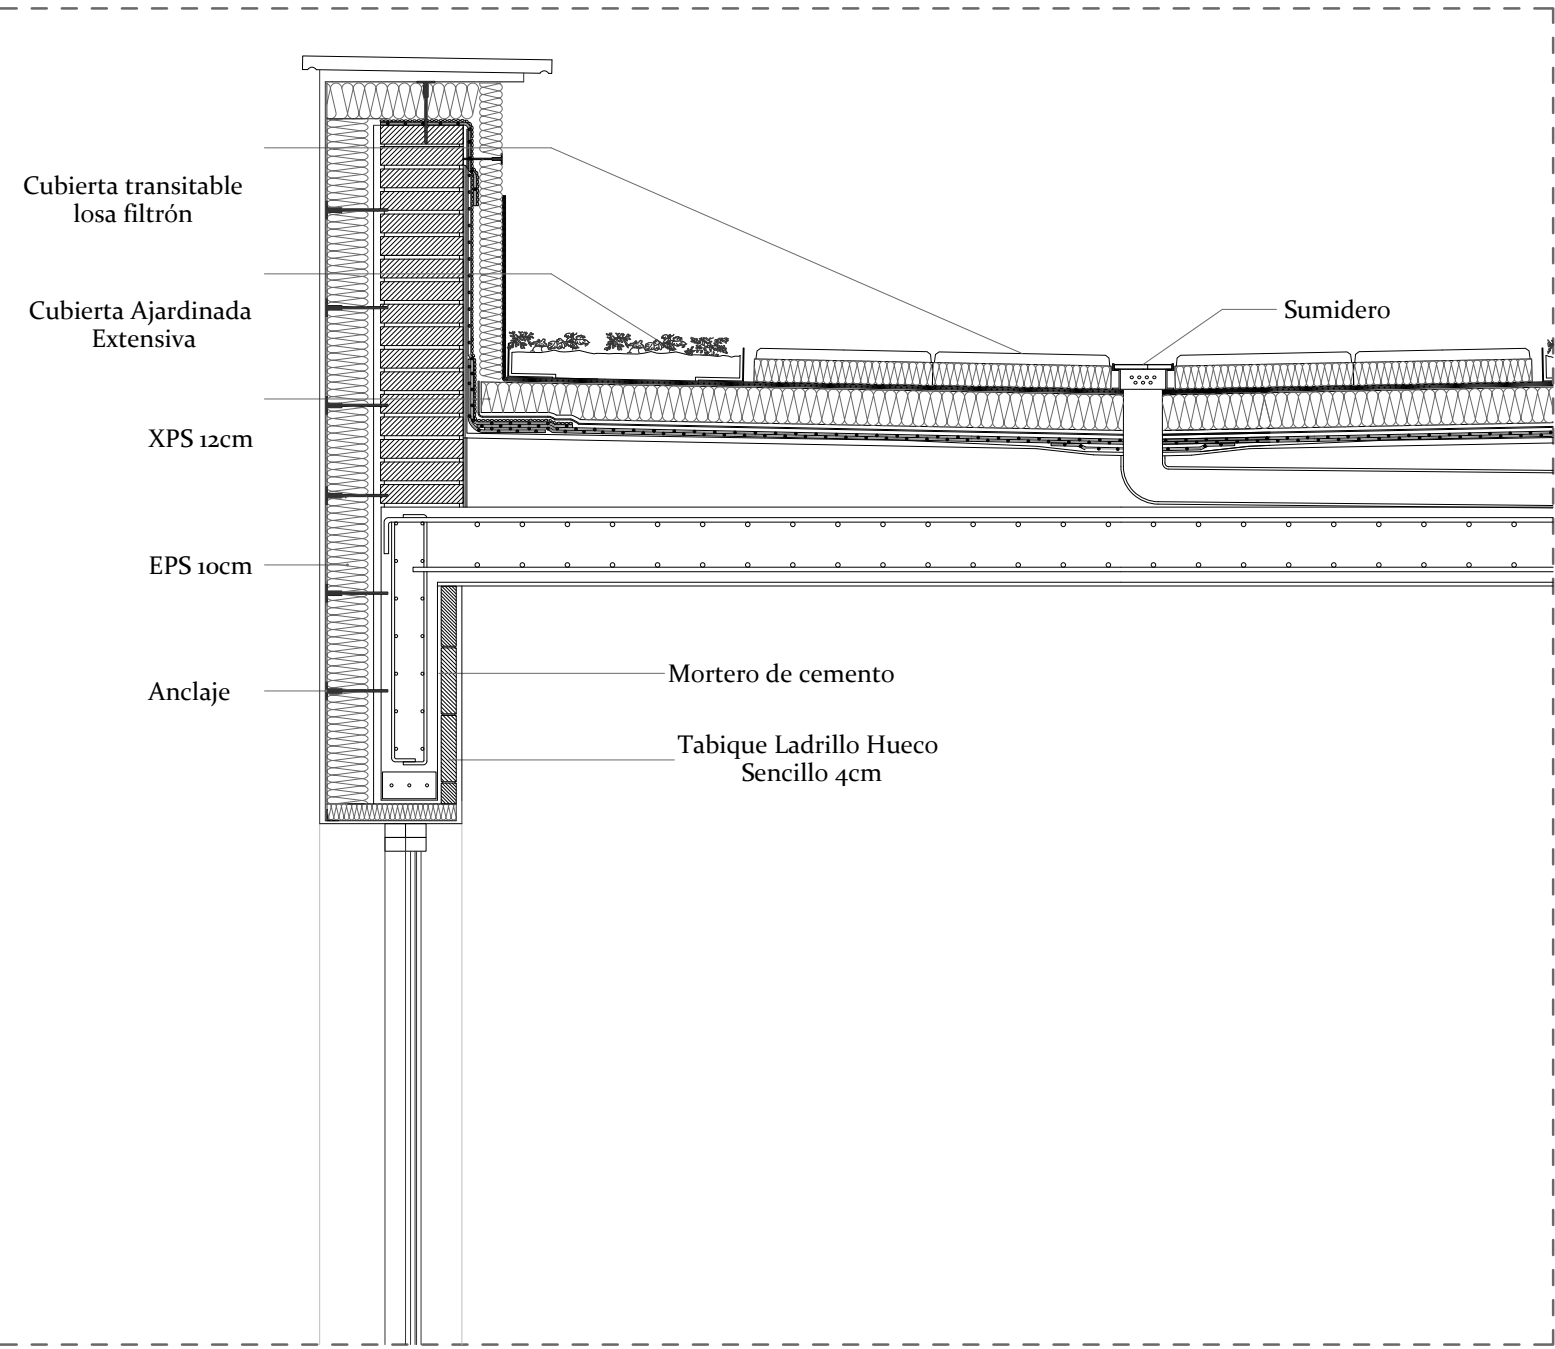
Detalles de la sección constructiva rehabilitada. Elaboración propia a partir del proyecto de ejecución.
